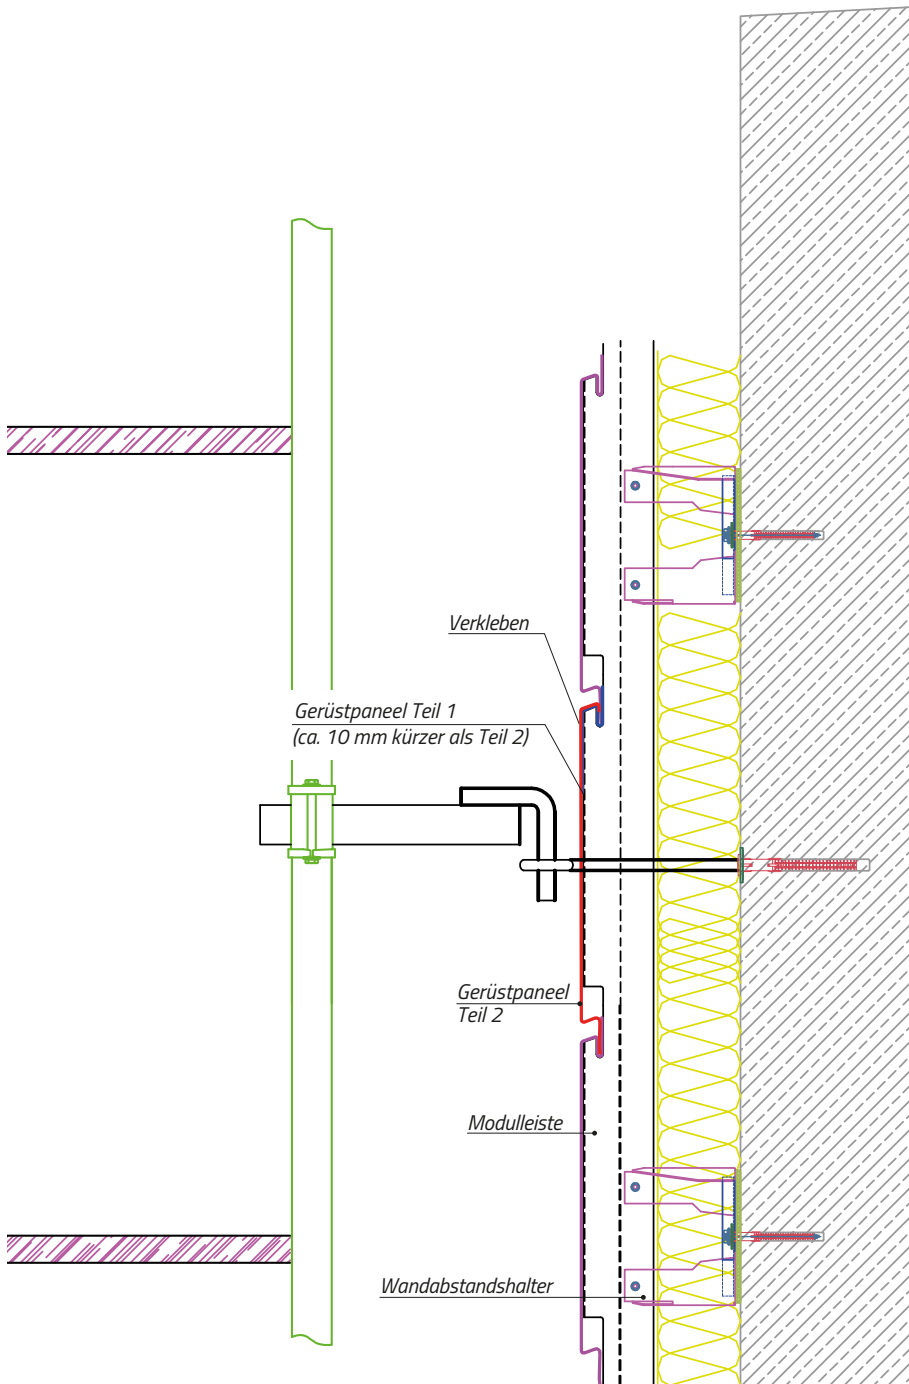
Schema Gerüstbefestigung und Gerüstpaneel
